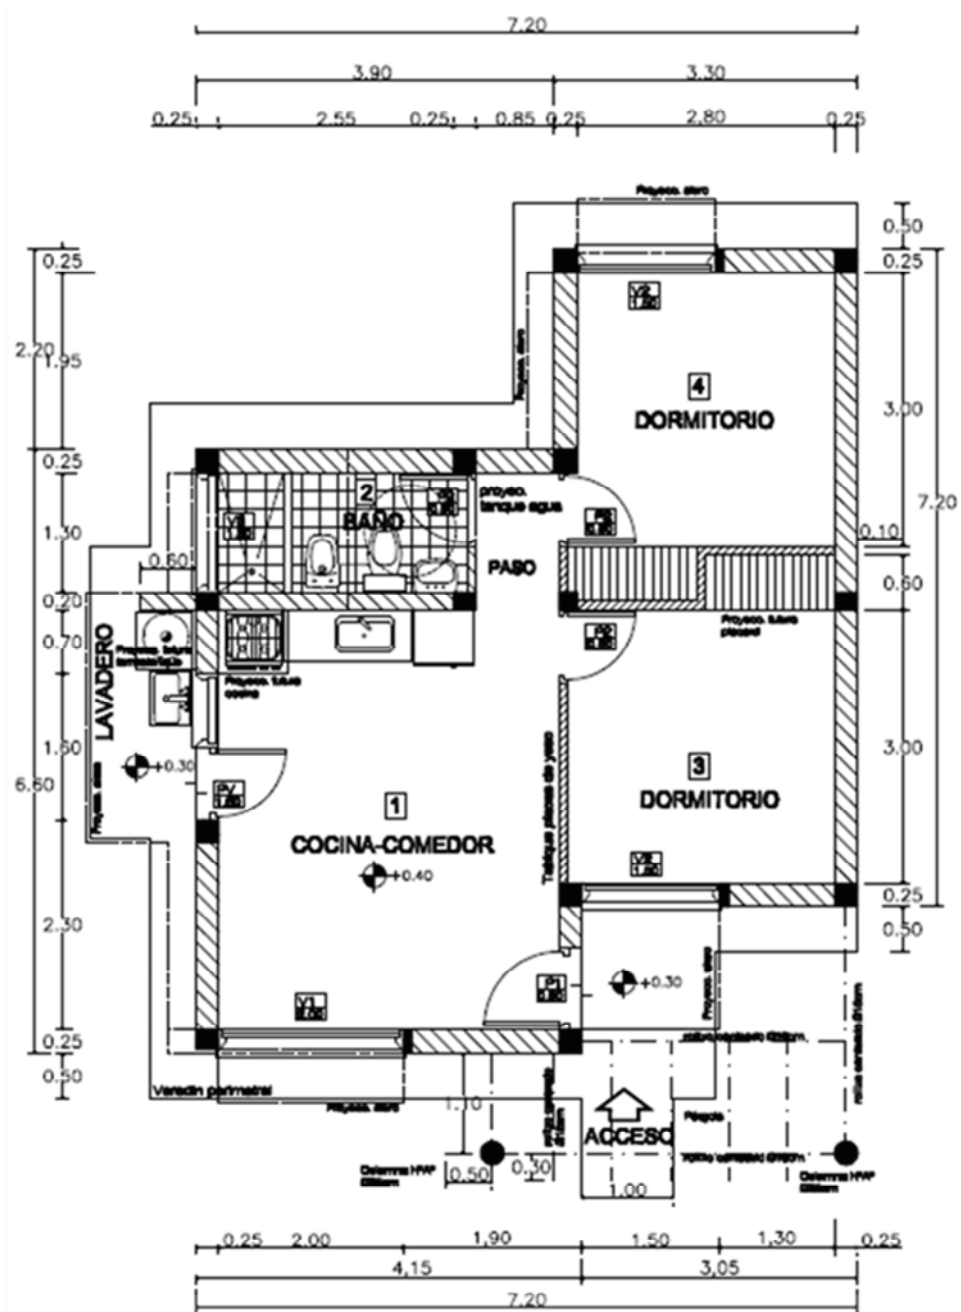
Planta de arquitectura de la vivienda de una planta.
